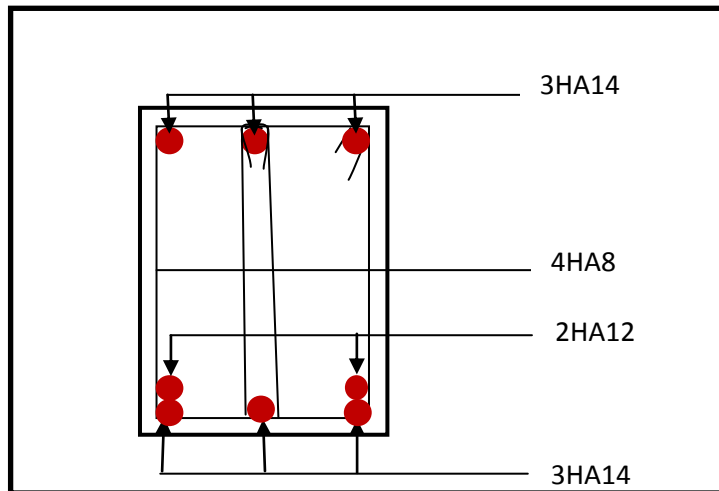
Ferrailage en travée d'une poutre secondaire.
